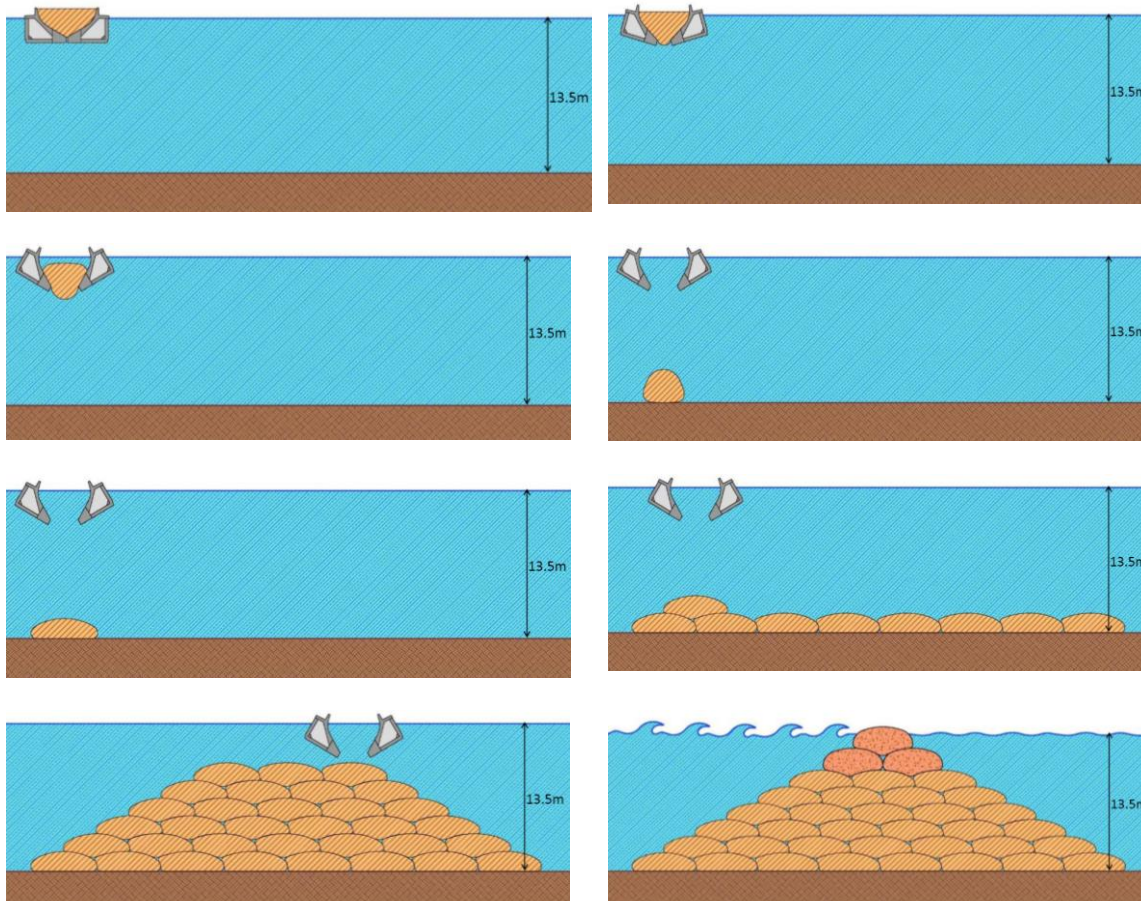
Avance en la construcción de un dique con Geocontainers, con Geotubos en las filas superiores
